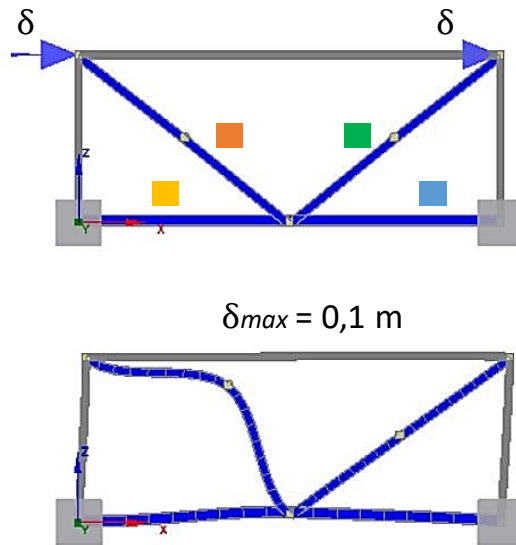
Modello 2D equivalente – schema pushover con instabilità nel piano
